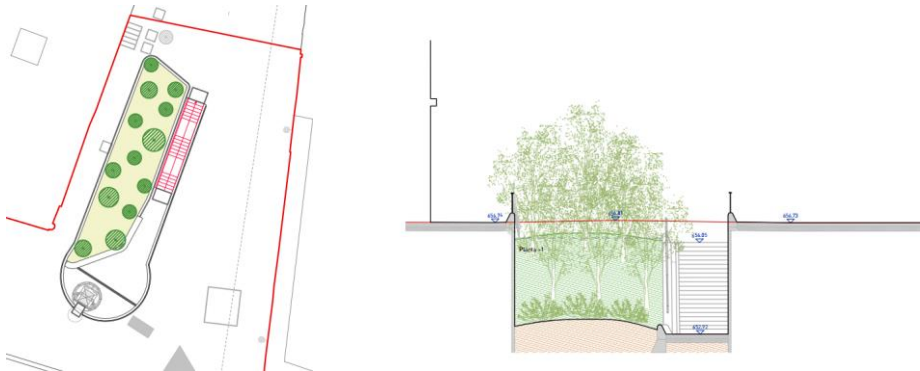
Planta y Sección transversal de arquitectura del nuevo acceso Calle Carretas.
